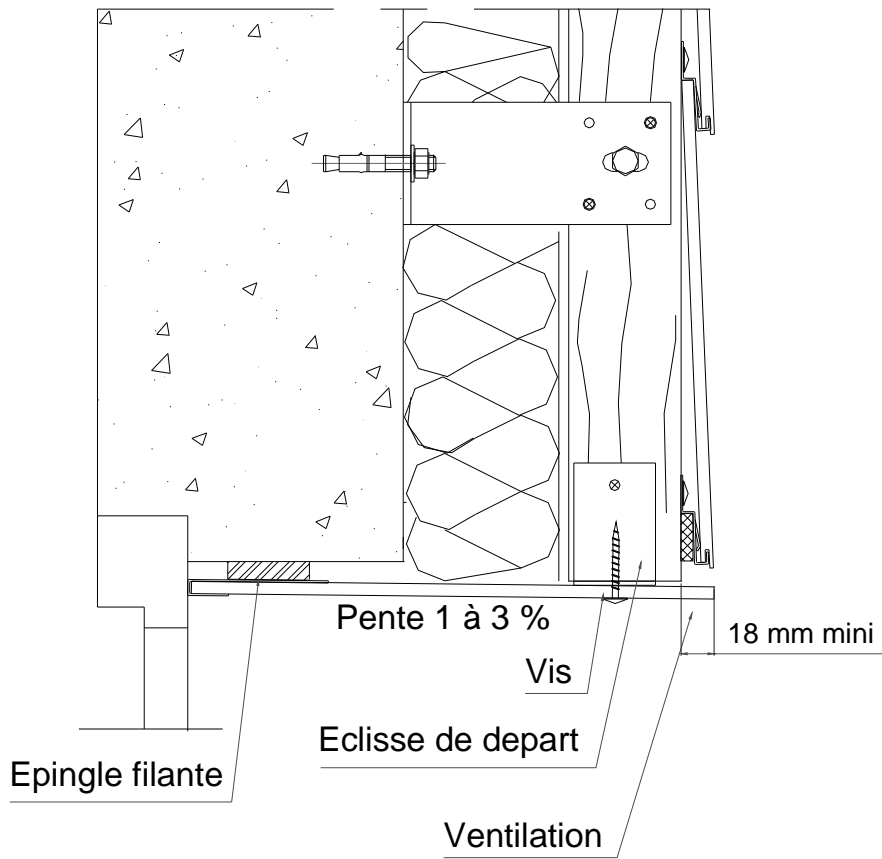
Détail linteaux – Panneaux FUNDERMAX Exterior
